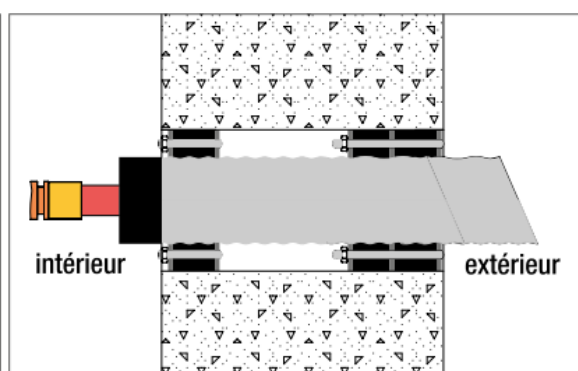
Bride murale étanche FA 40 et FA 80 - vue latérale.
